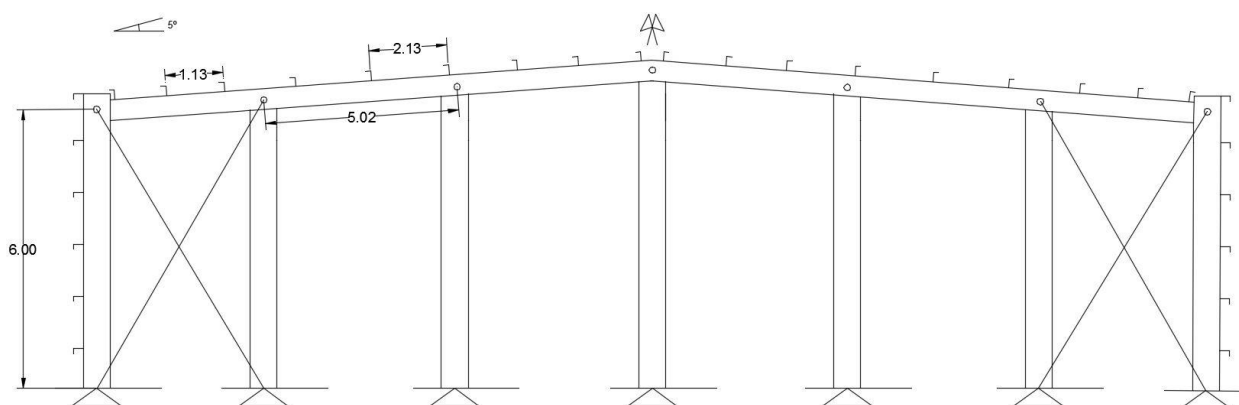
Pórtico tipo 2 (pórtico de fachada)
